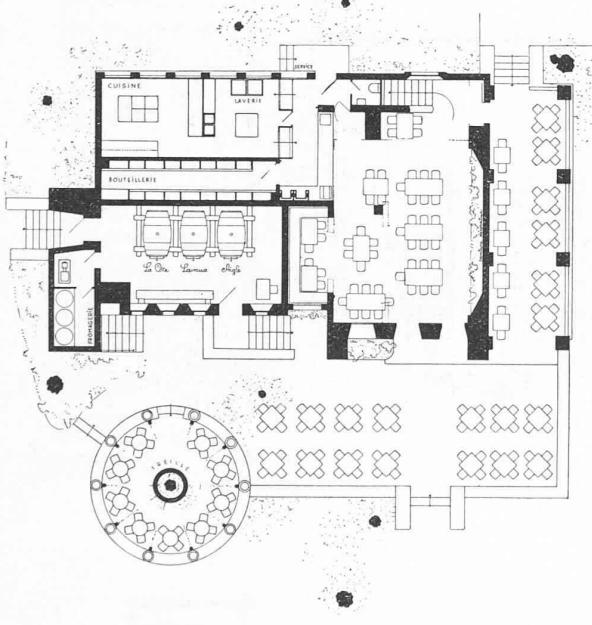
La « Cave vaudoise ». Plan du rez-de-chaussée.
